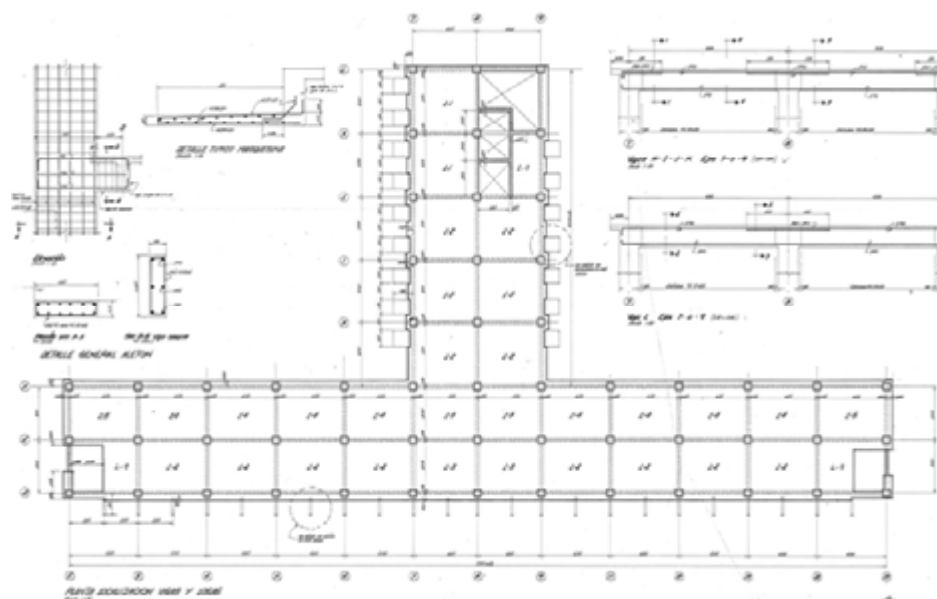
Planta de localización de vigas losas, niveles de 2 a 5.
